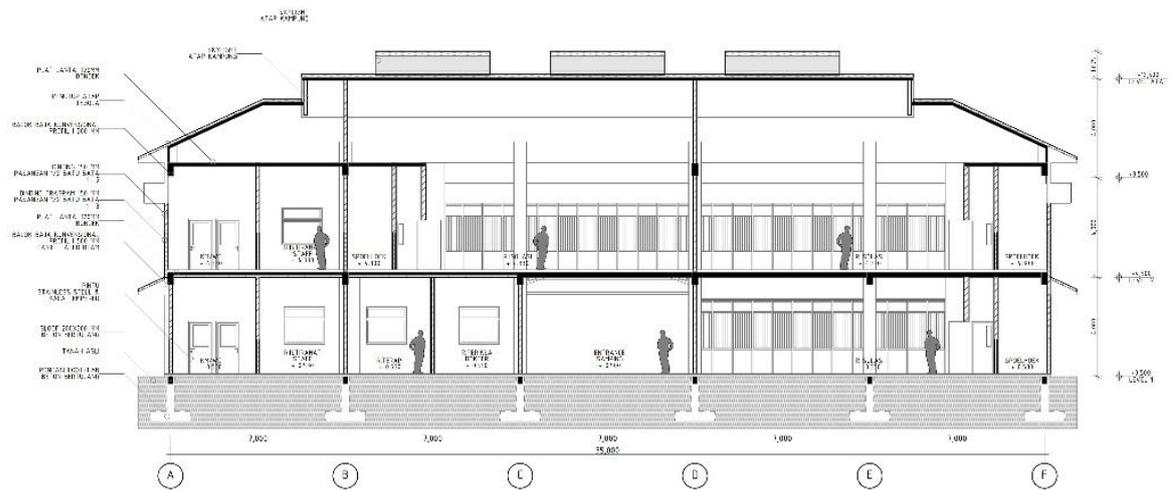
8 Denah dan Tampak Bangunan Isolasi
